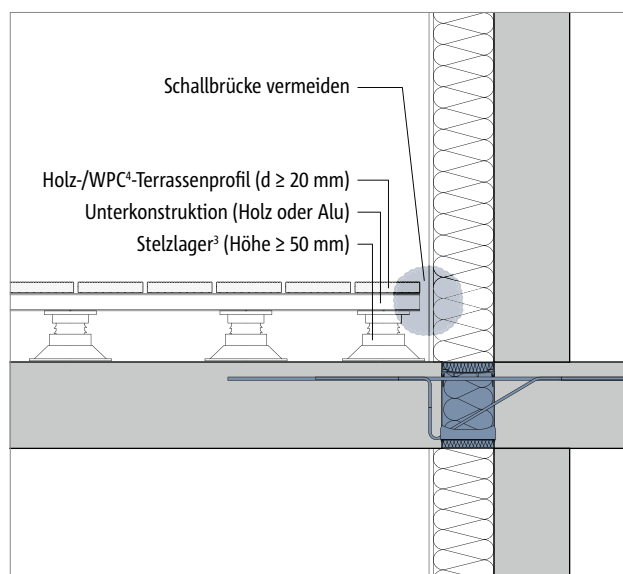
Balkonbelag mit Holz-/WPC-Terrassenprofilen, Unterkonstruktion (Holz oder Alu) und Stelzlager
